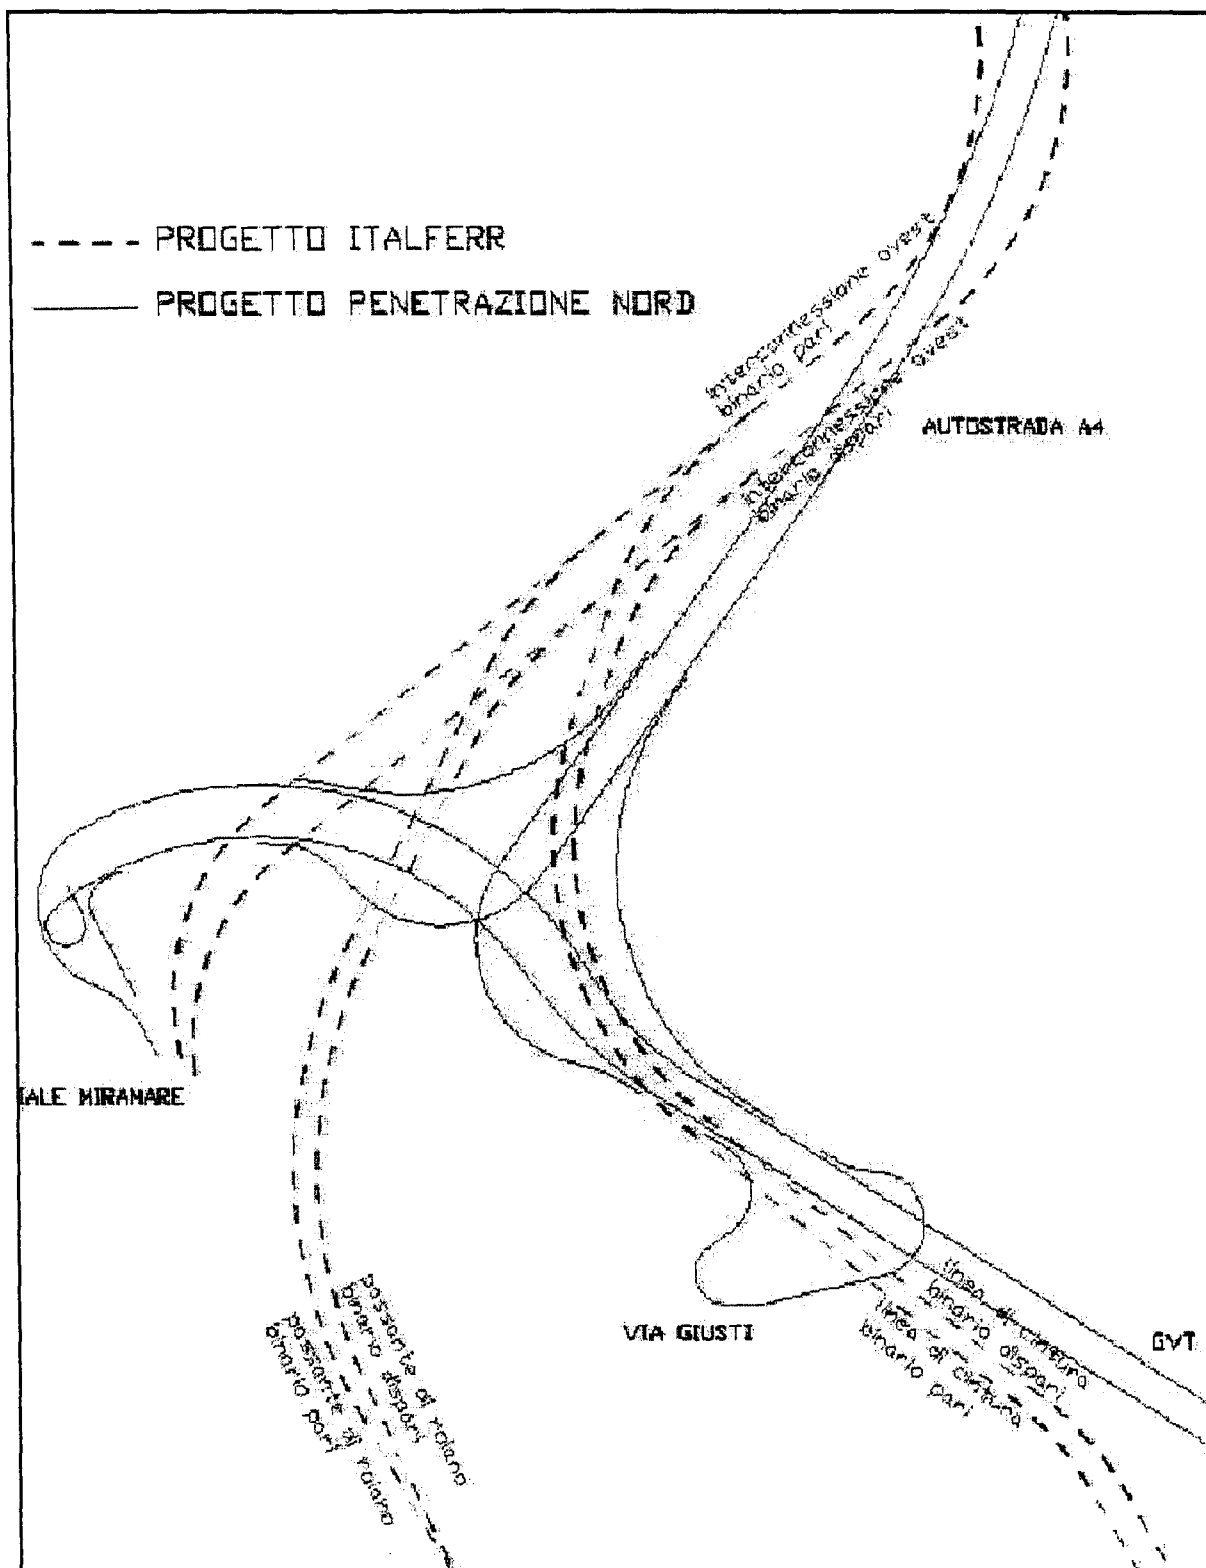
La planimetria della configurazione iniziale del progetto stradale sovrapposta alle gallerie ferroviarie del progetto Italferr
